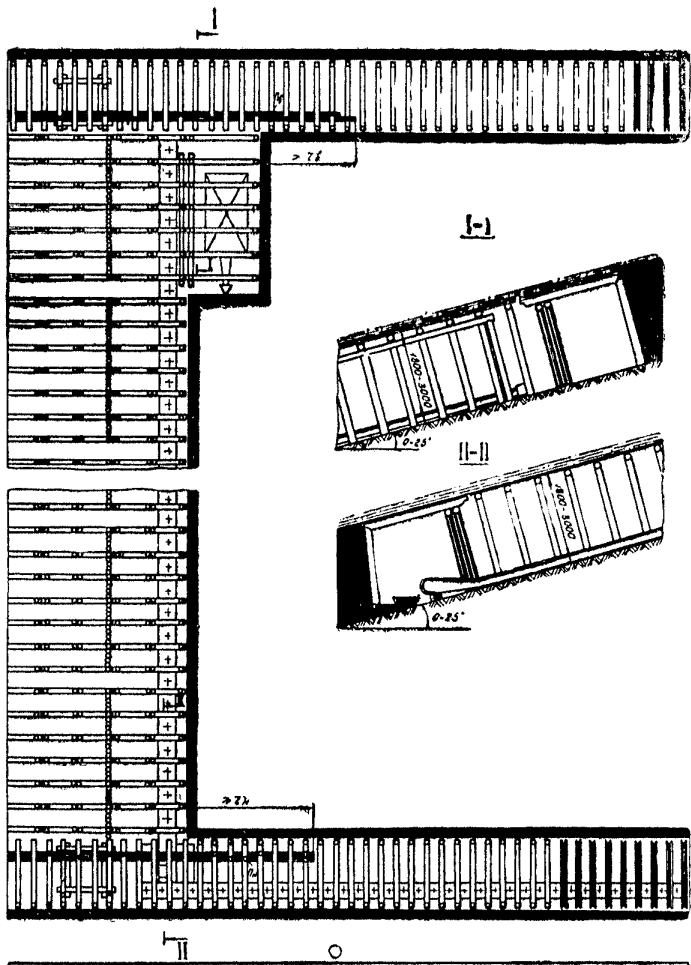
Типовой паспорт крепления сопряжений лав со штреками на пологих пластах с неустойчивыми кровлями при выемке угля комплексами.
